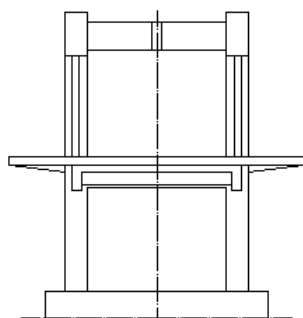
Tenká stěna podpírající oblouk vyztužený trémem
